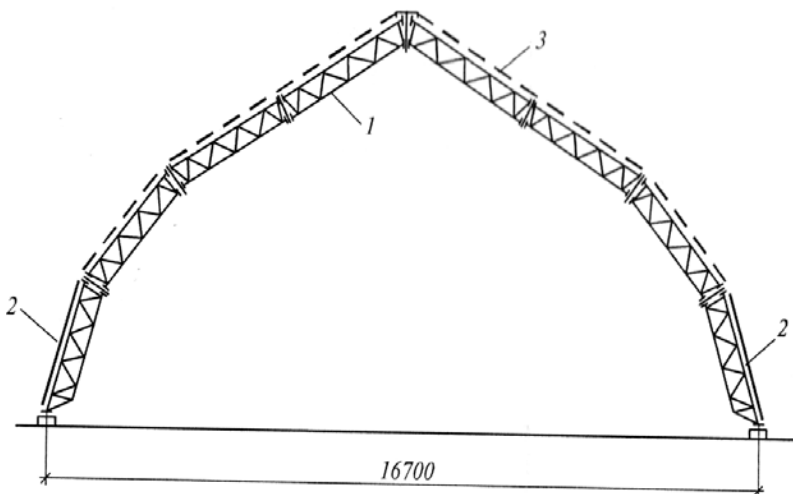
Поперечный разрез арочного здания с тентовым покрытием:
